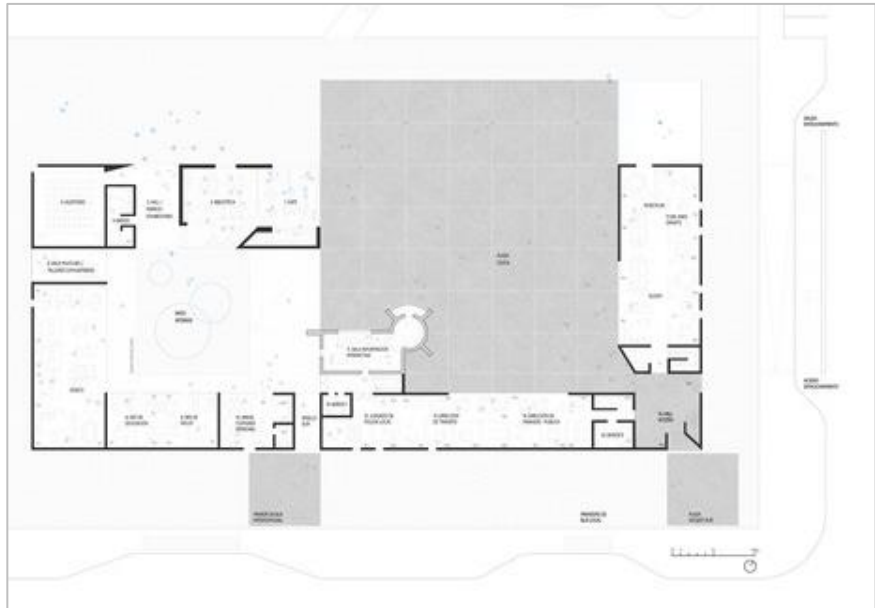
Planta del proyecto de la municipalidad de Papudo.
